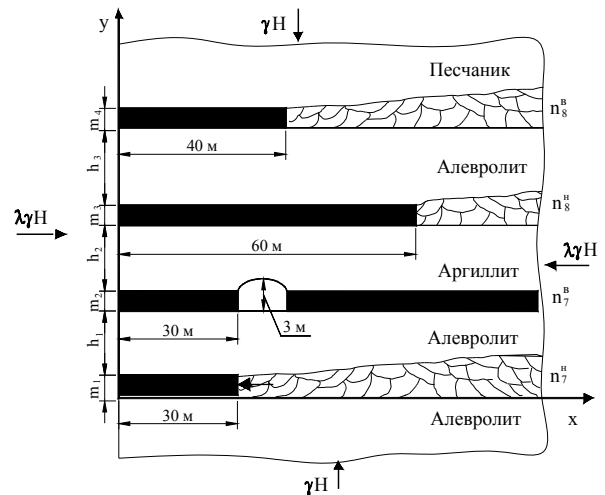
Расчетная схема к определению НДС вокруг выработки
